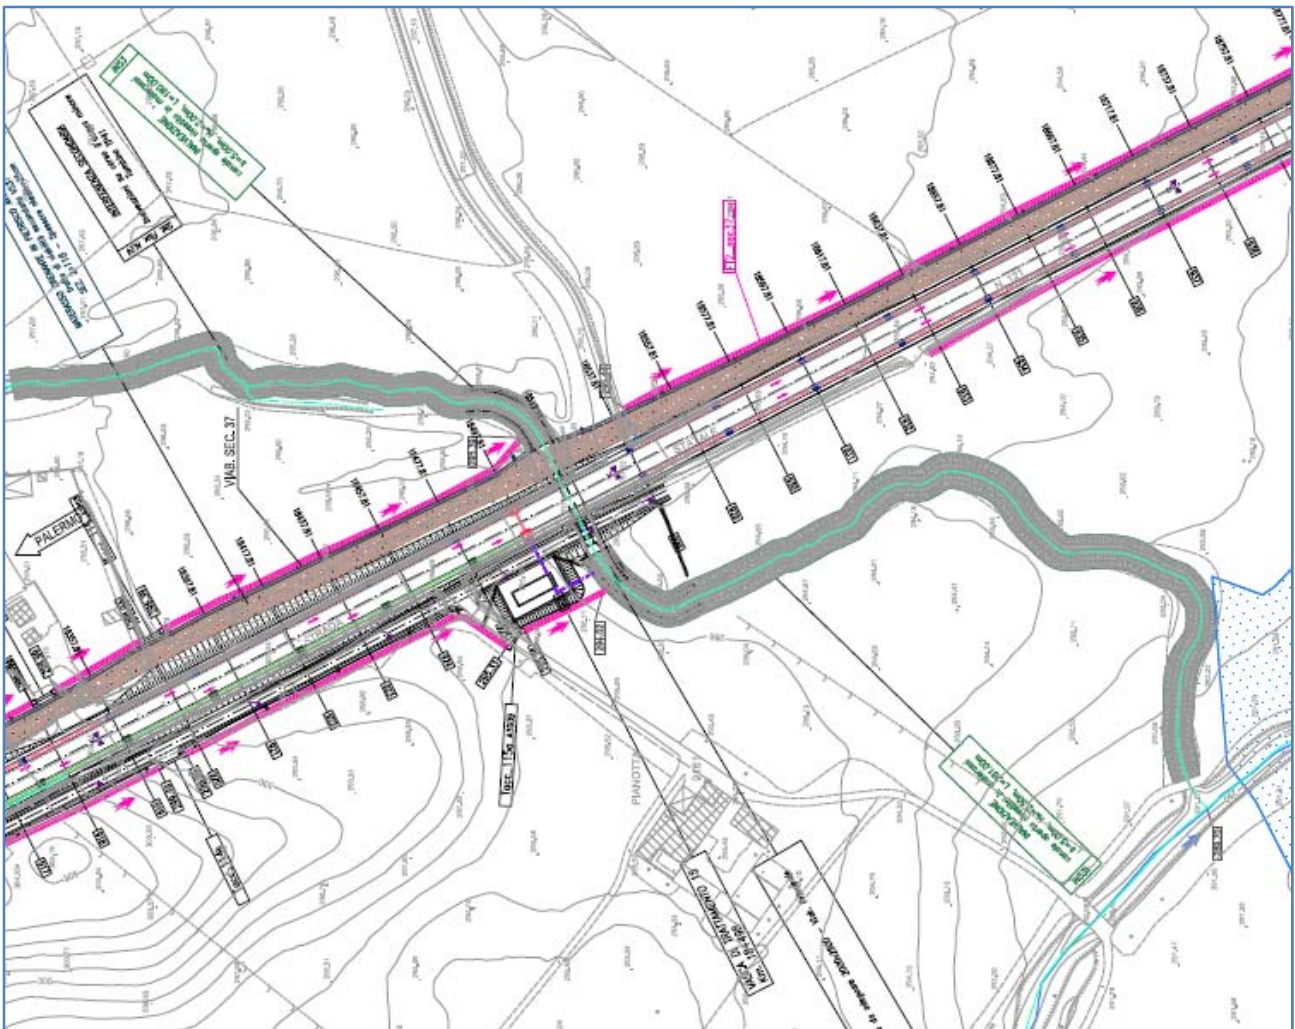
Stralcio planimetrico dell'elaborato di P.V.T.2 – codifica PEID_P021_51_4137.
